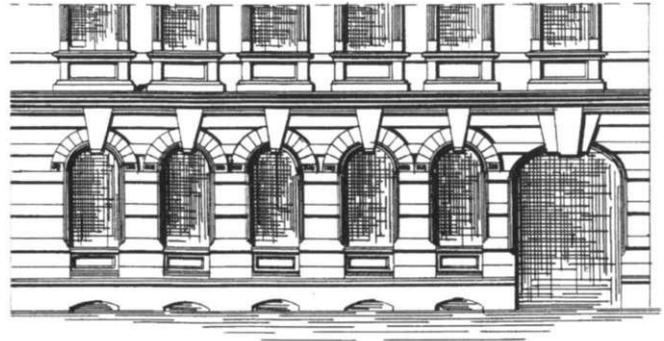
Immermannstraße 29, Ansicht Erdgeschoß vor dem Ladeneinbau
